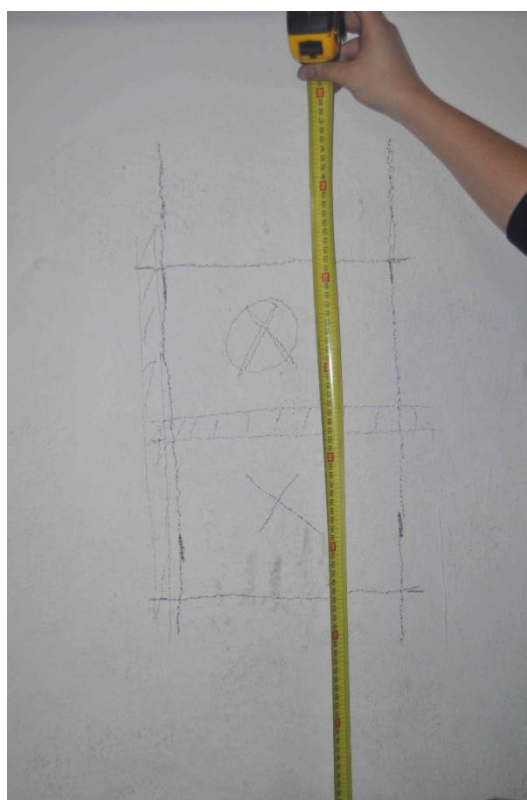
Dispunere etrieri pe zona curentă a stâlpului B/7
